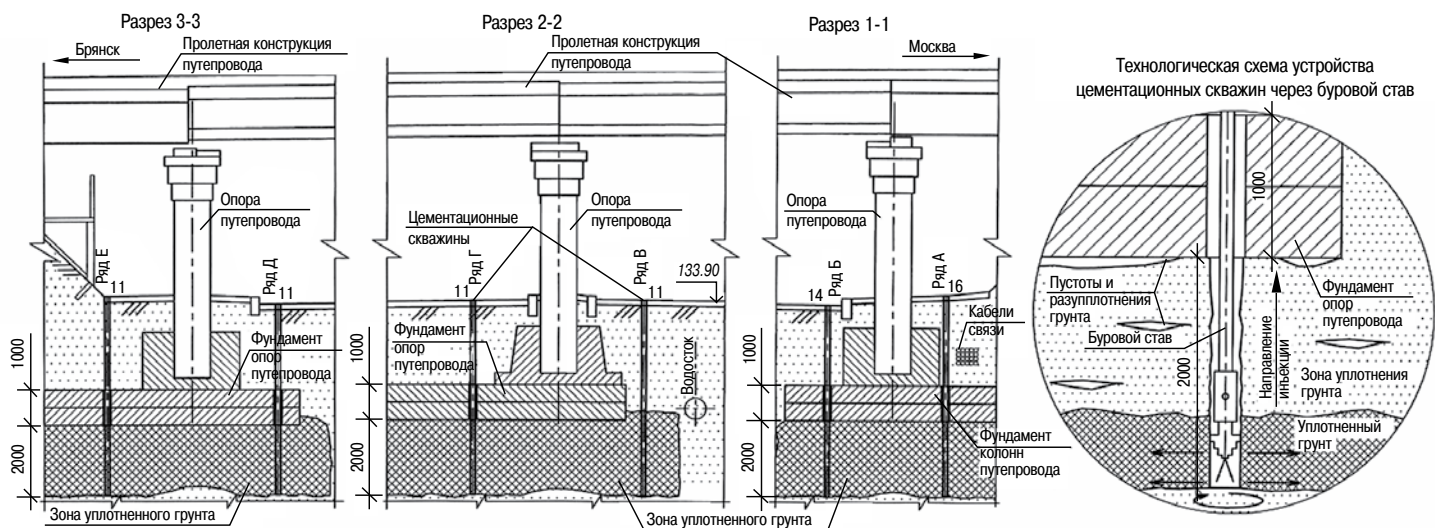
Схема цементационных скважин в основании фундаментов опор путепровода
